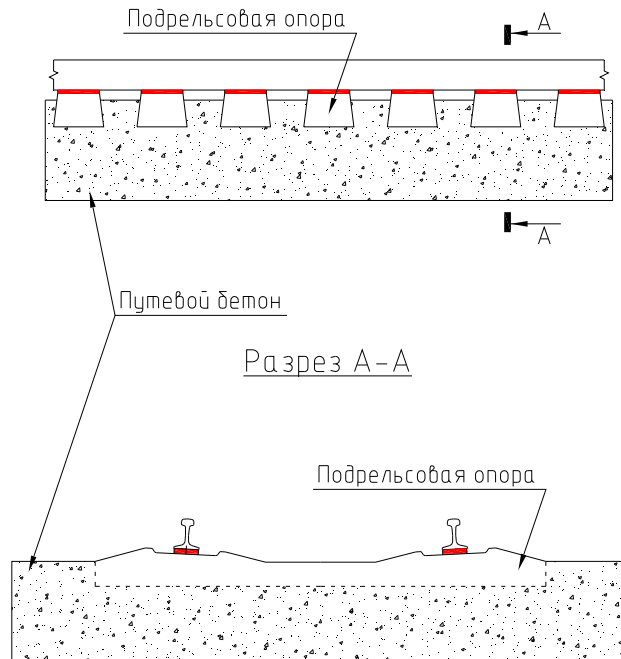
Тип 4. Безбалластный путь с омоноличенными в путевом бетоне подрельсовыми опорами с типовыми упругими промежуточными скреплениями без специальных мероприятий по снижению его жесткости. На мостах аналогом этой конструкции является путь на деревянных поперечинах и БМП с прокладным слоем из мелкозернистого бетона
